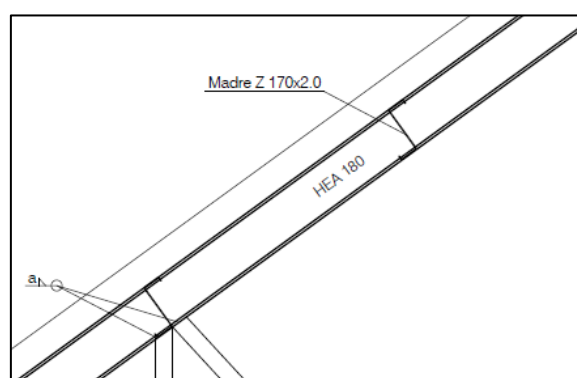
Corte da cobertura (Pormenor madre e HEA) [22]
